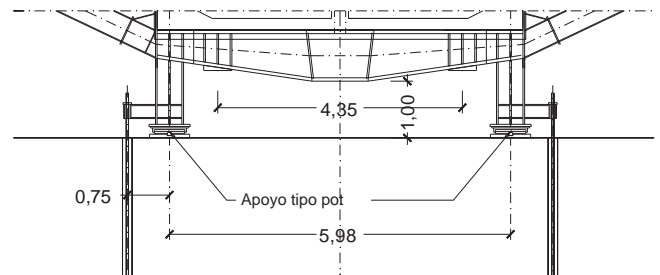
Estructura metálica de apoyo en estribos y sistema antilevantamiento.
